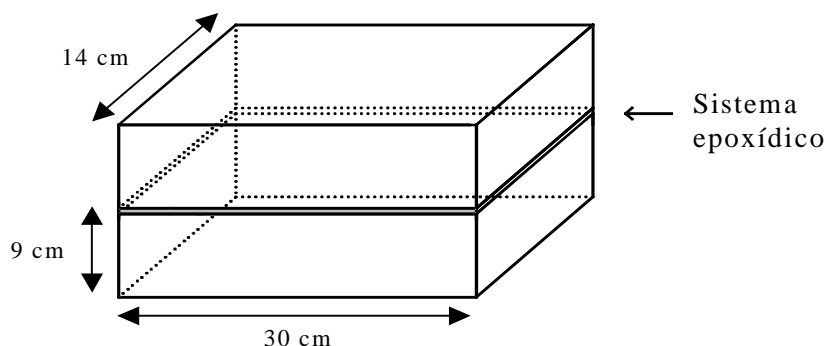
Provetes prismáticos resultantes da colagem de dois prismas de betão.
